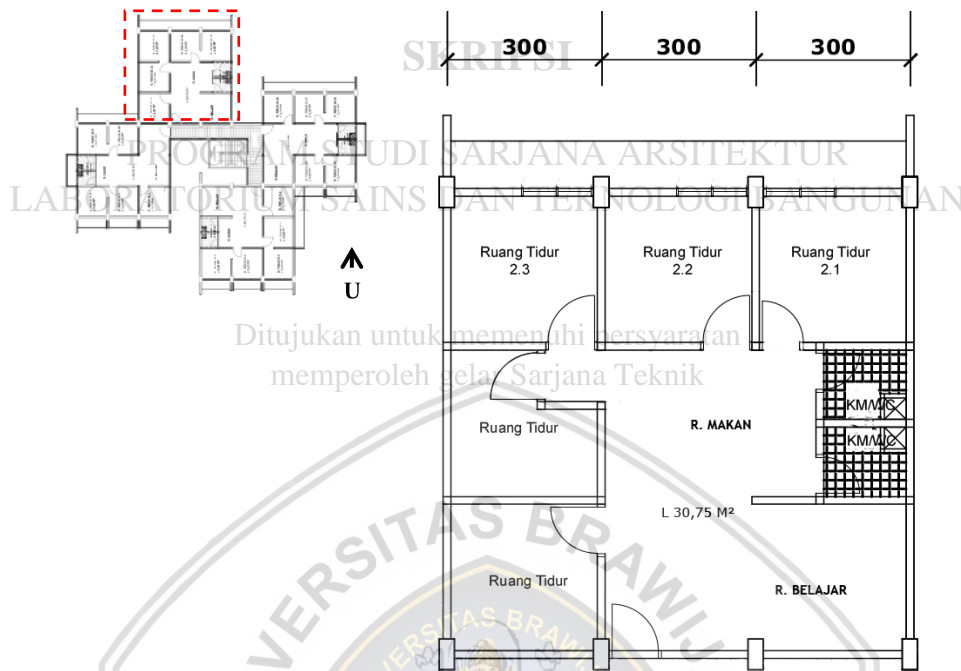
Denah Gedung A Asrama Griya Brawijaya Lt. 2-4
